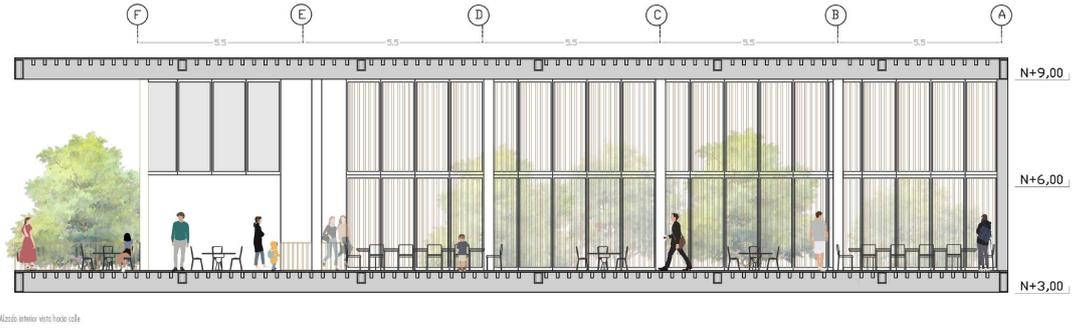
Alzado interior 1 pizzería. Elaboración propia
